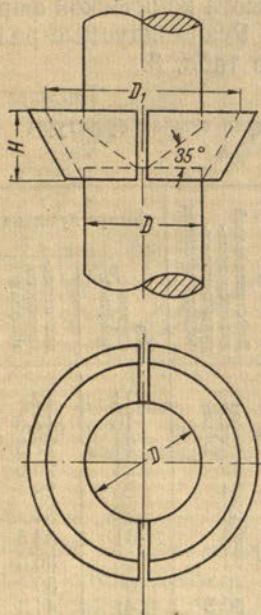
Стык вертикальных стержней, подготовленный к ванной сварке
